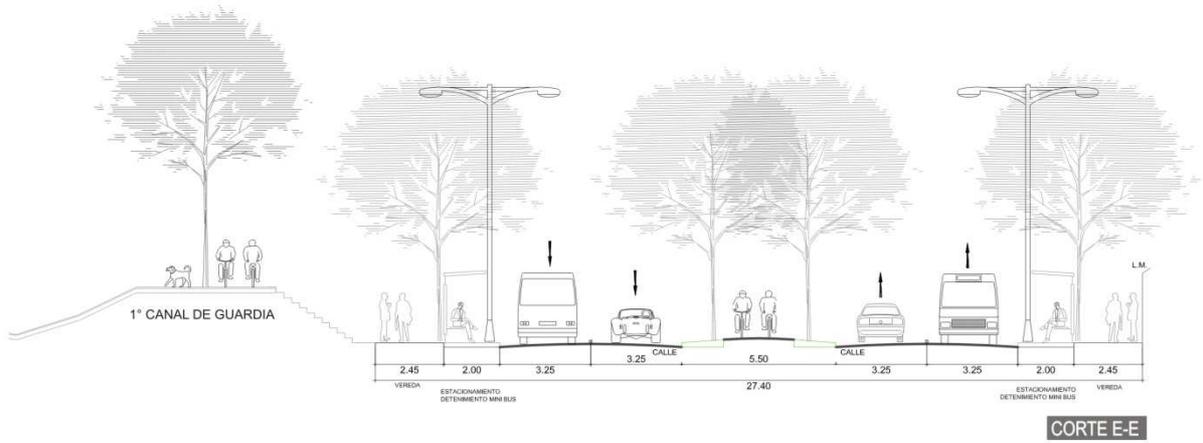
Modelo Espacial: Plano de ubicación y corte E-E ilustrando la propuesta de desarrollo urbano para el Corredor N° 3
